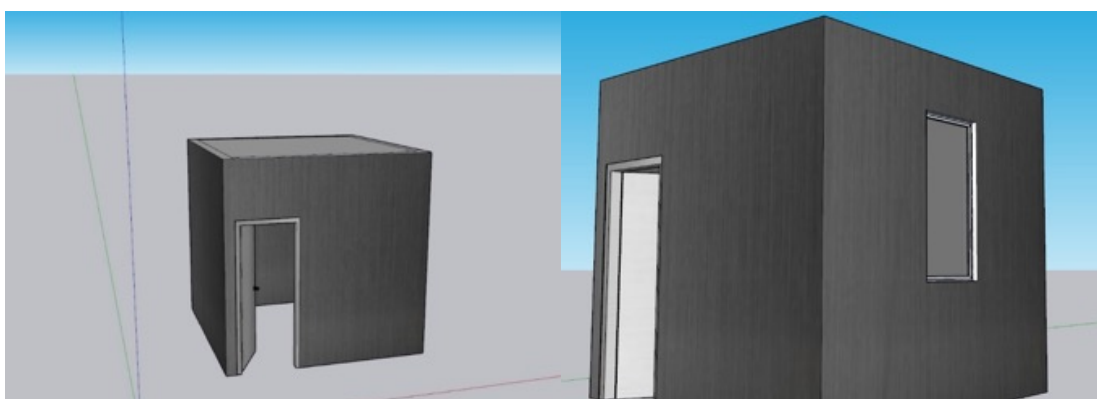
Plano de la cabina metálica. Fuente: Elaboración propia, 2022.
